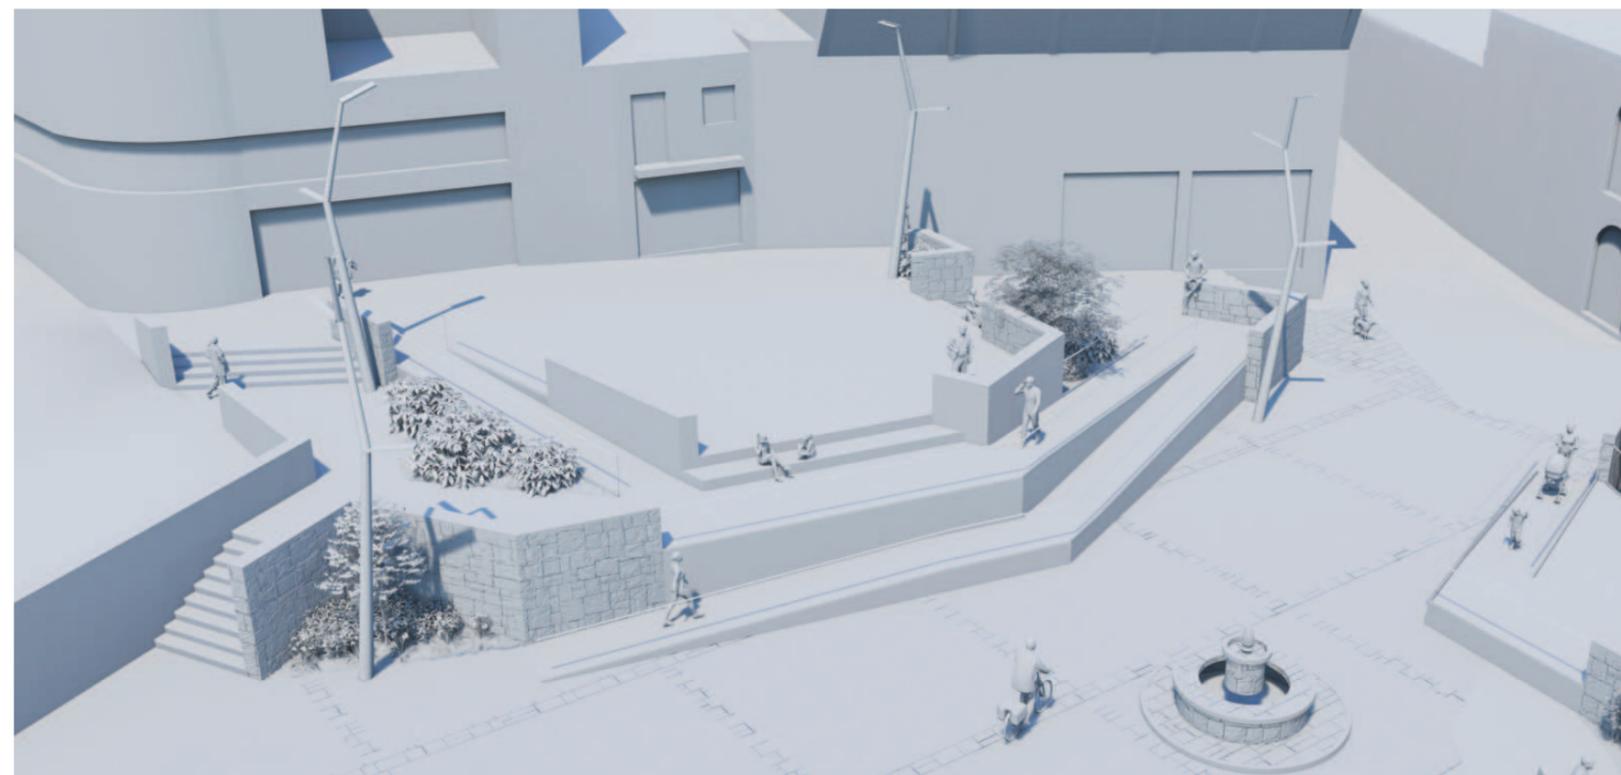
Estado reformado de Zona 1. Elaboración propia
